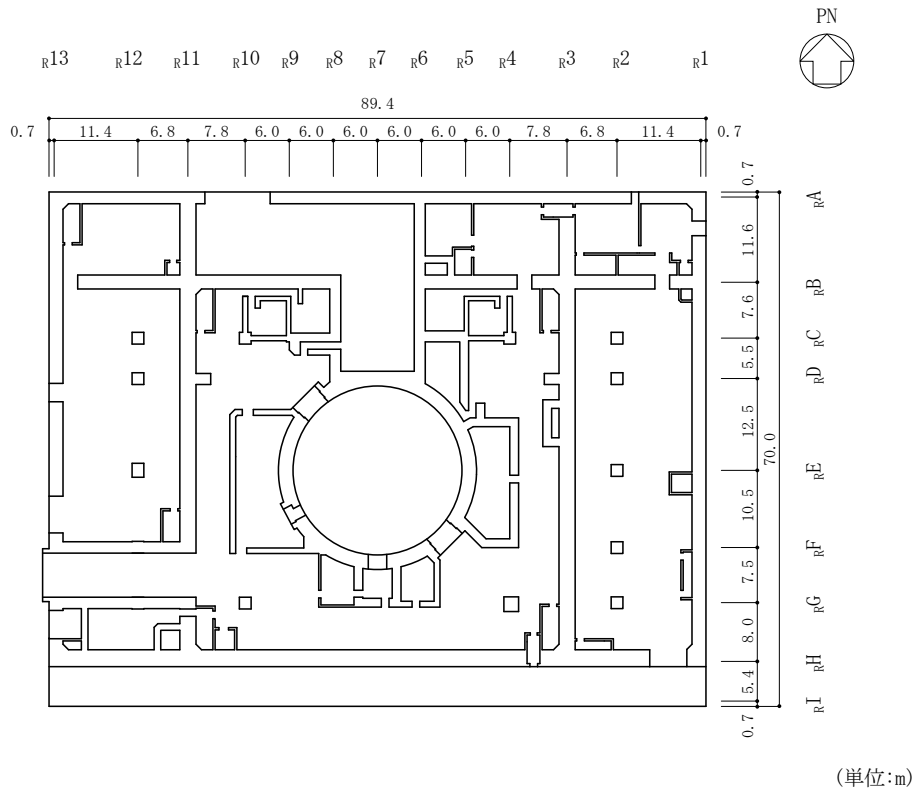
(3) 原子炉建物の概略平面図 (EL 15.3m)
